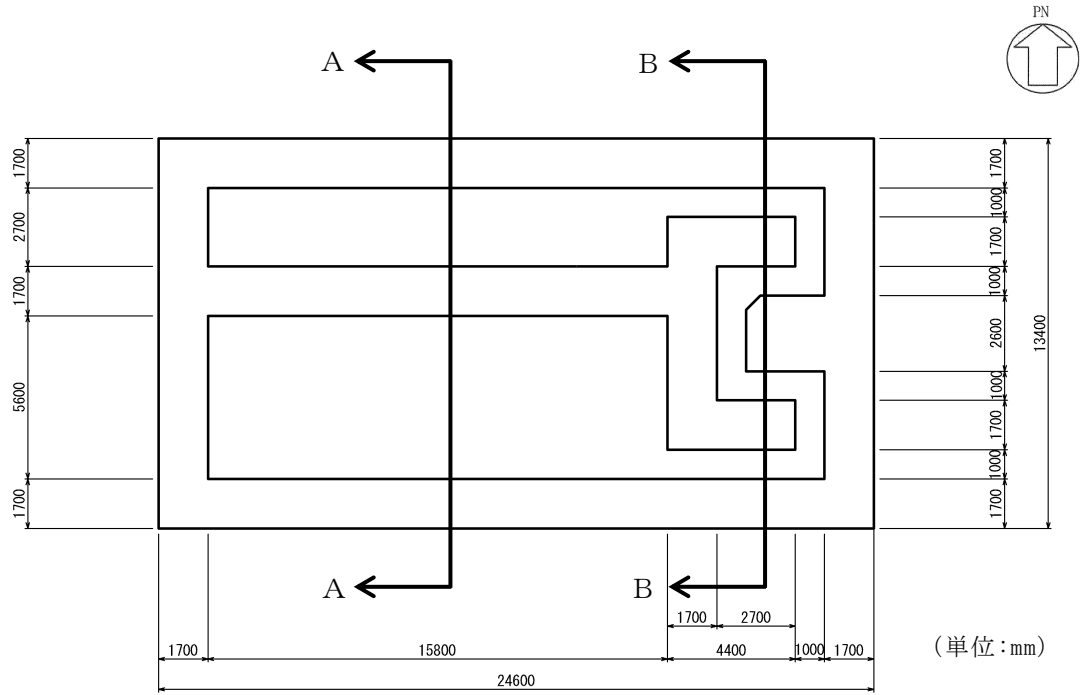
第1ベントフィルタ格納槽 評価対象断面位置図
